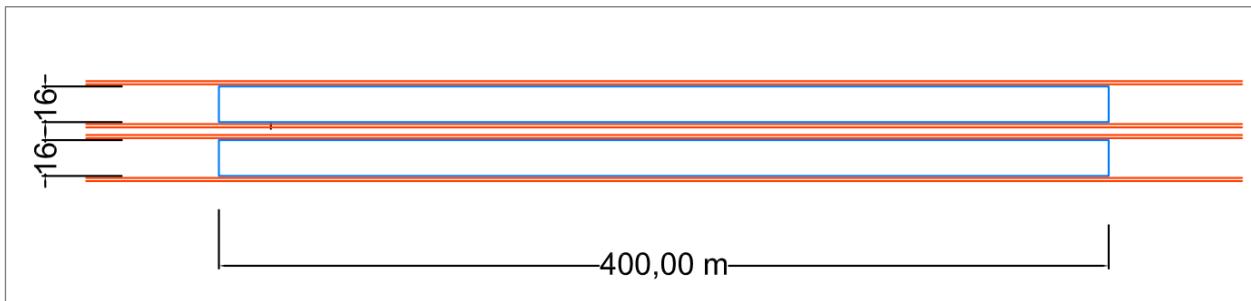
Proposta de referência para layout de estação do tipo “de Passagem”.
